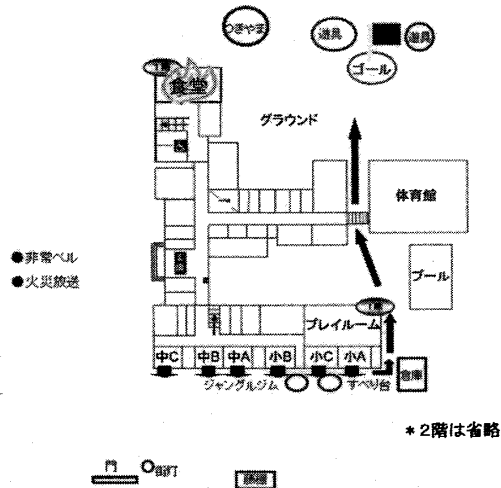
校舎平面図 (参照：附属養護学校 HP3))
